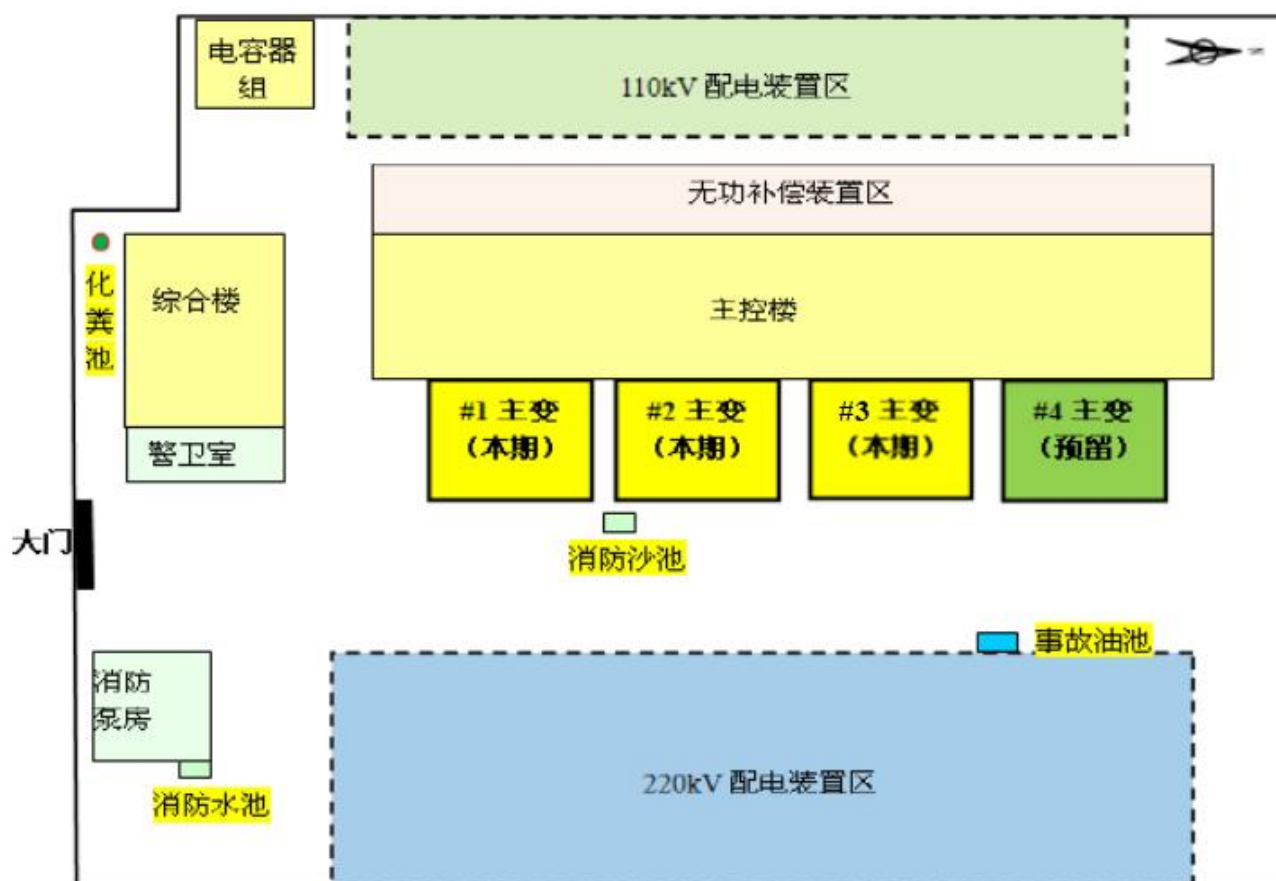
惠州 220 千伏荣田变电站总平面布置示意图（监测时）
